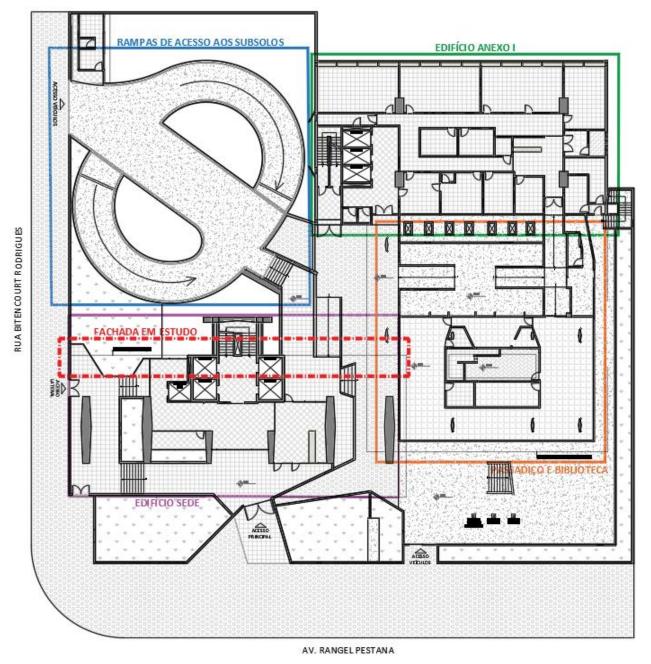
Localização da fachada que contemplam os brises de concreto.
